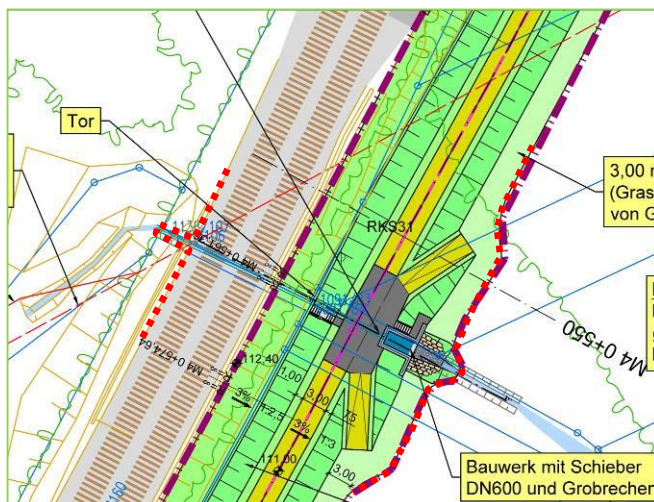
Auszug M4 Lageplan, Teil 1 - Bahndamm Vorschüttung (M 1: 1.000)
